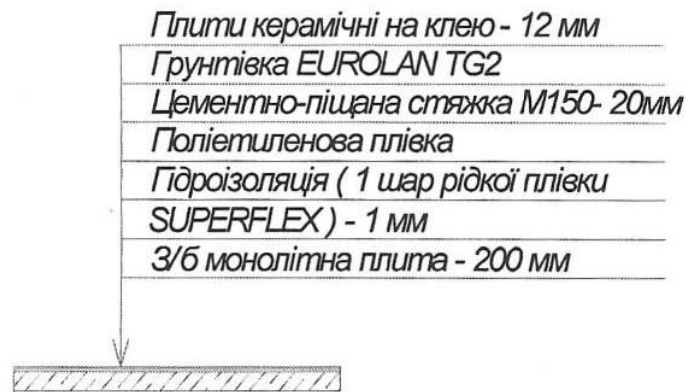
Конструкція підлог санвузлів другого і мансардного поверхів.
